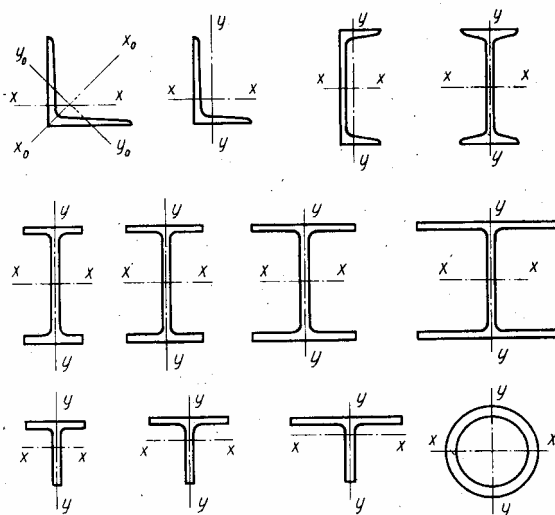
Сортамент основных конструкционных стальных прокатных профилей
